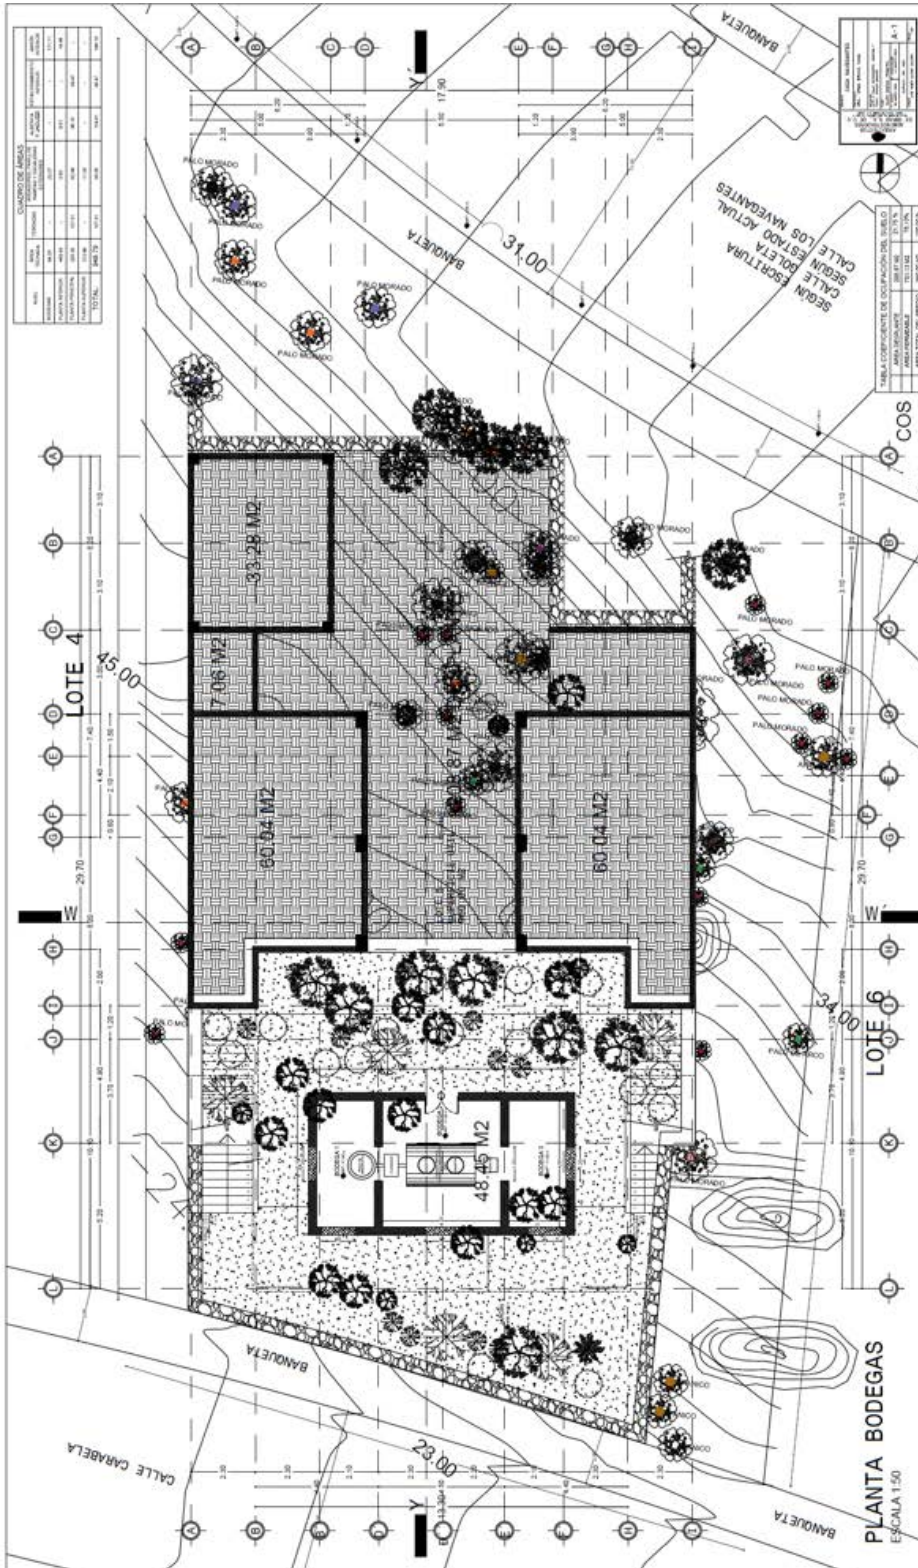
Plano con la Planta de las Bodegas (Incluye desplante)
